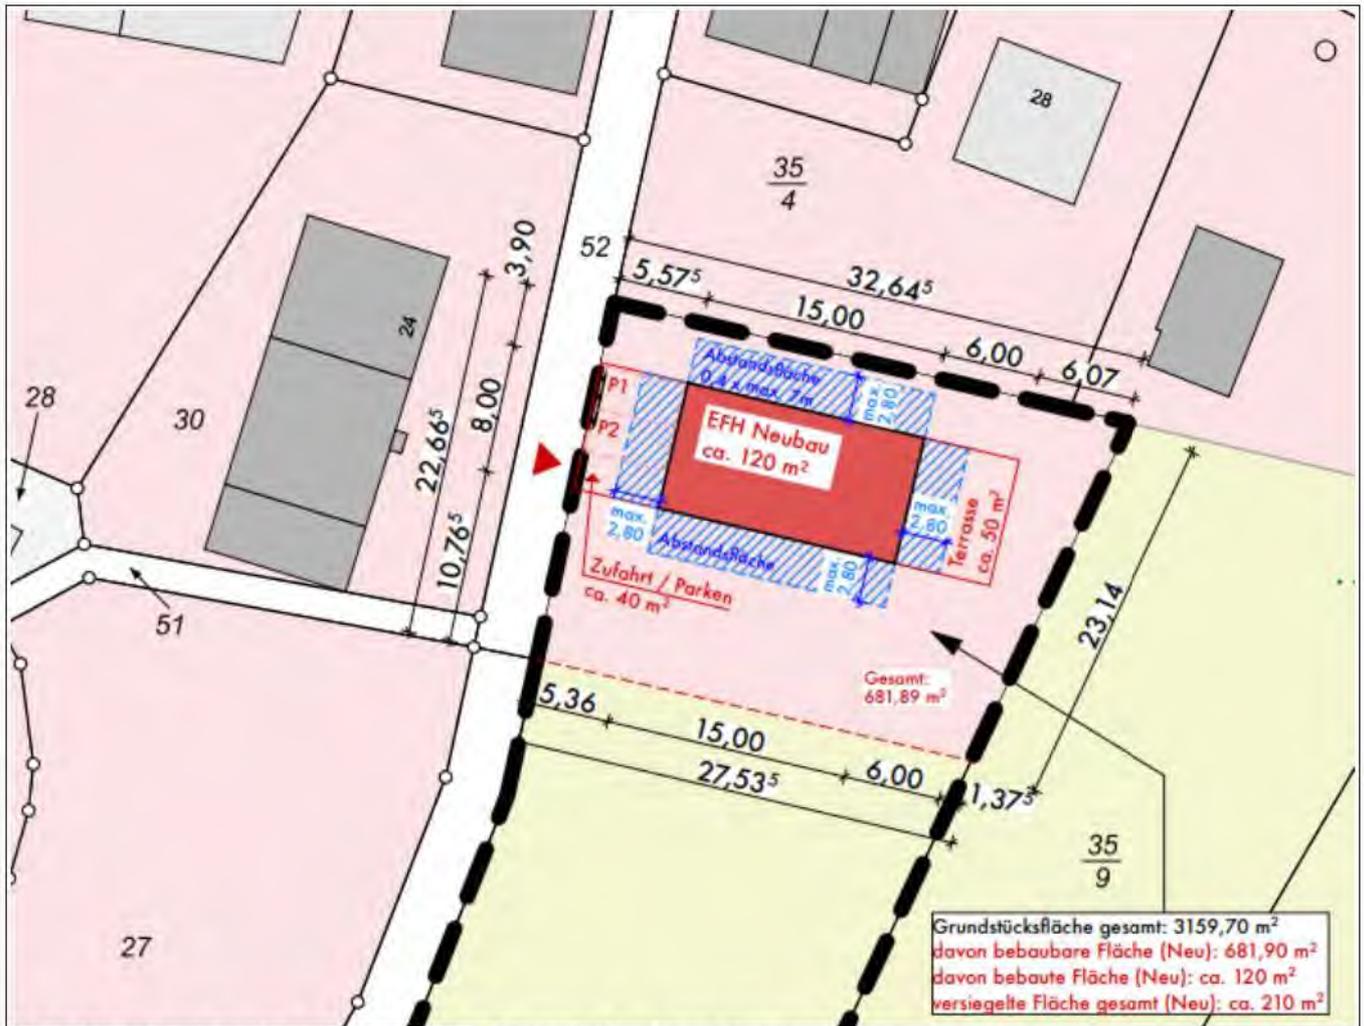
Bauvorhaben mit Geltungsbereich der Abrundungssatzung
